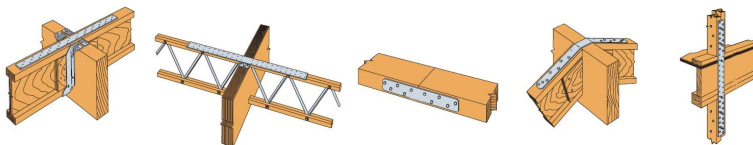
Exemplos de aplicação das fitas metálicas (adaptado de STRONGTIE, 2008).
